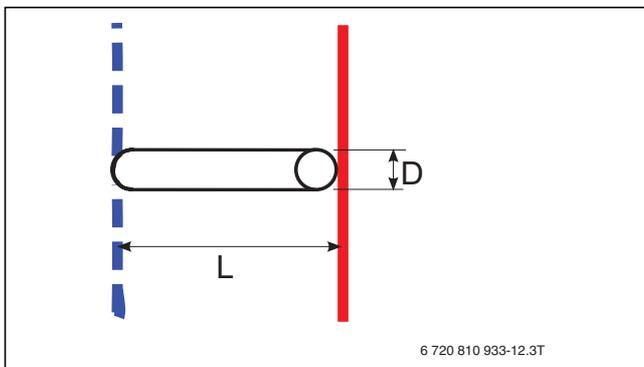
Bypass Detailsicht (→ [1] [ASE/ASB] Abb. 5 und 6)
